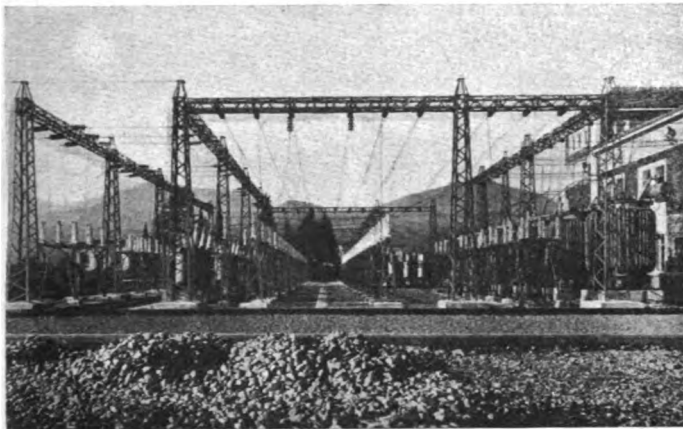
Sottostazione elettrica all'aperto di Pontremoli.
